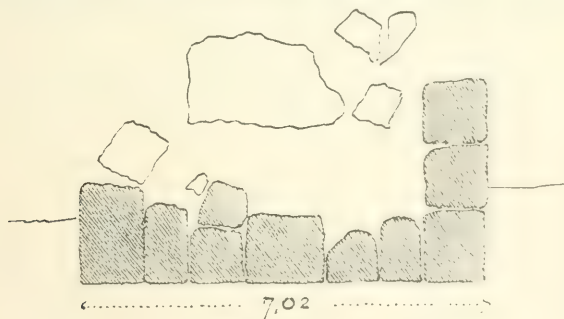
Eflatun-Bunar. Grundriss.
